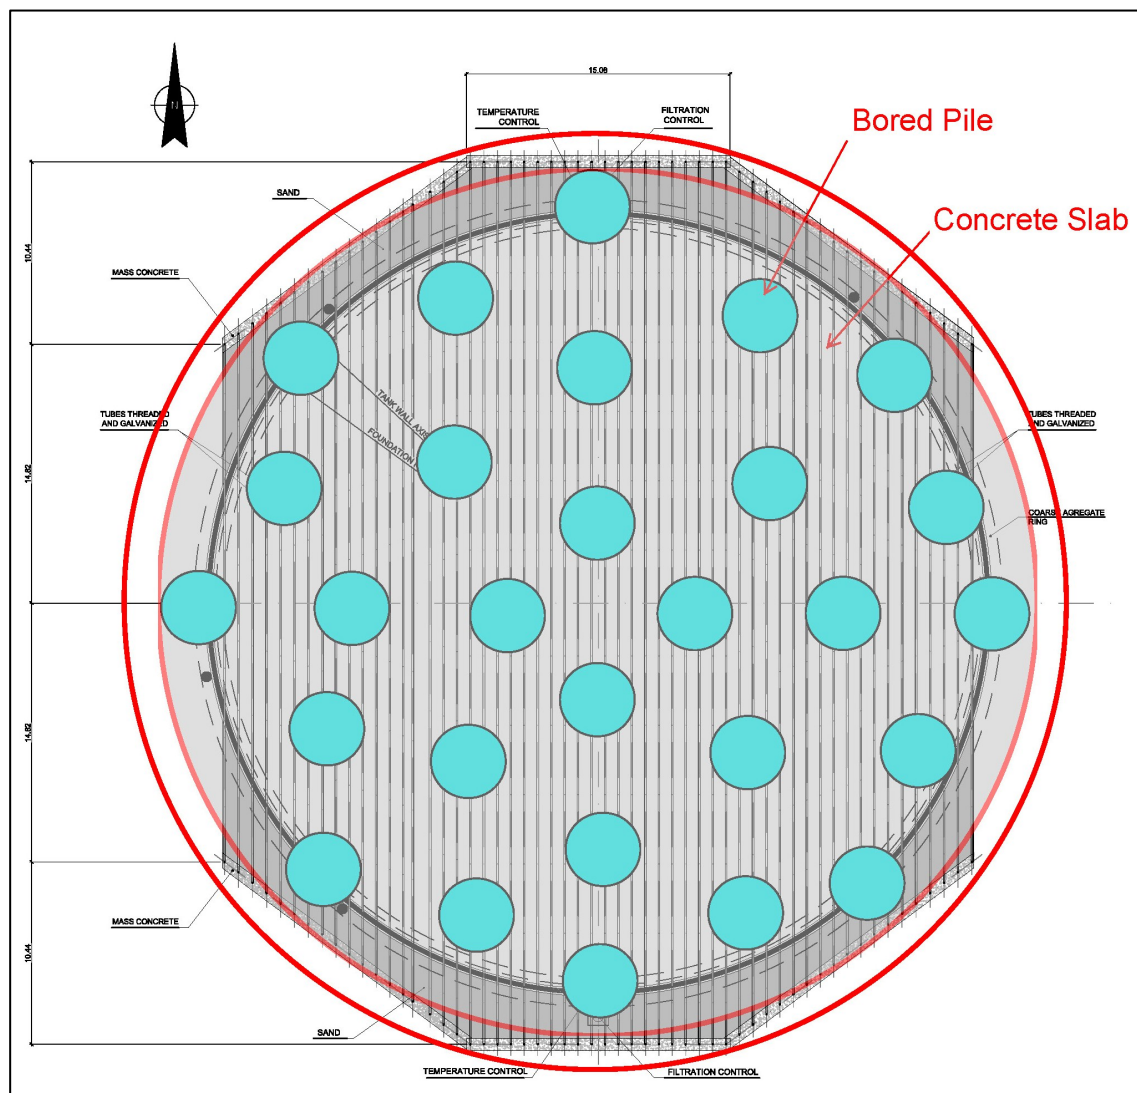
pianta della fondazione dei serbatoi (il numero dei pali rappresentato in figura è puramente indicativo)
